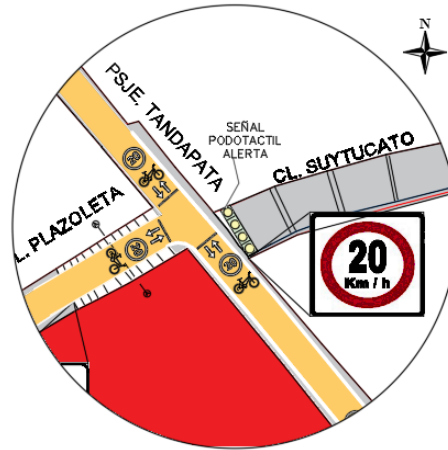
Pavimento táctil de alerta en la calle Tandapata con Pasñakapana
